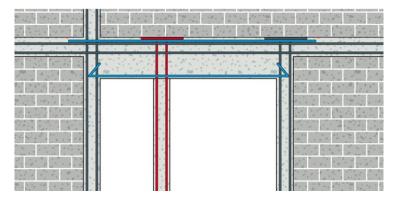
Armatures longitudinales du poteau, des chaînages et du linteau
